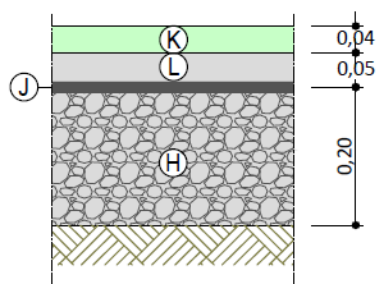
Pormenor do pavimento Tipo V – Estacionamento Ligeiros
